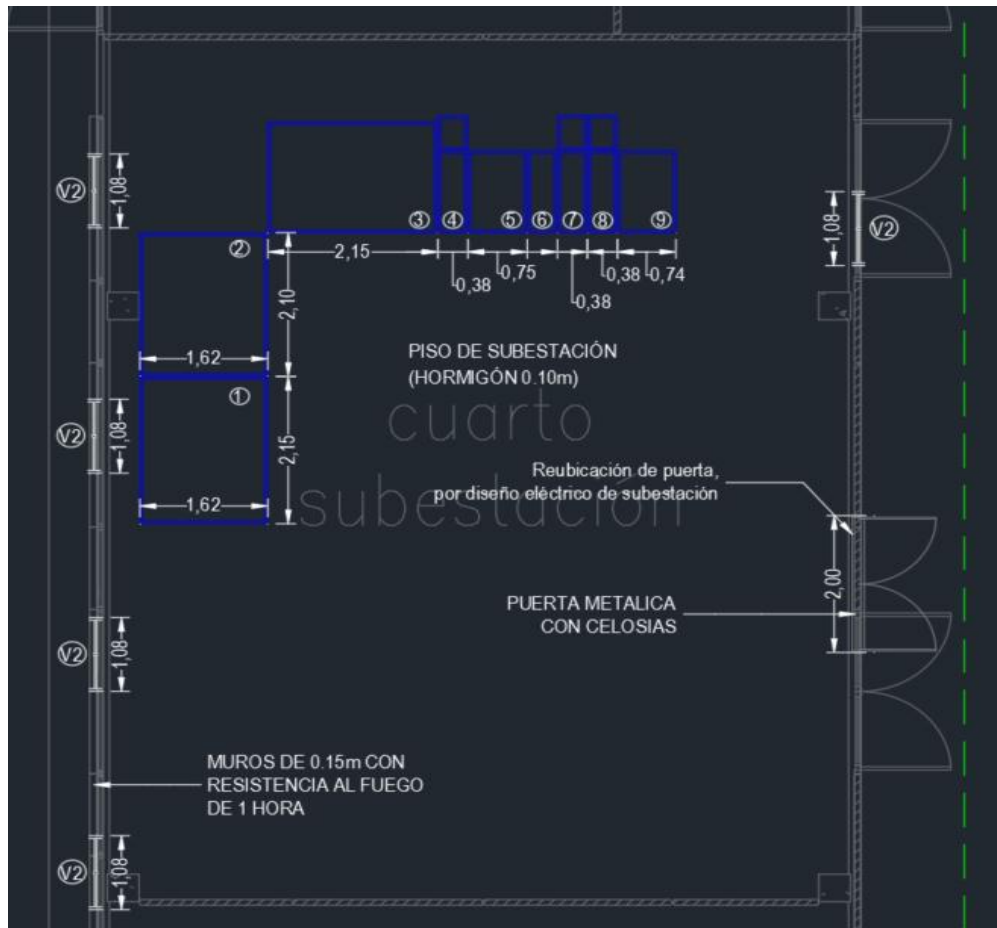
Detalle de la distribución y dimensiones de la Subestación.
